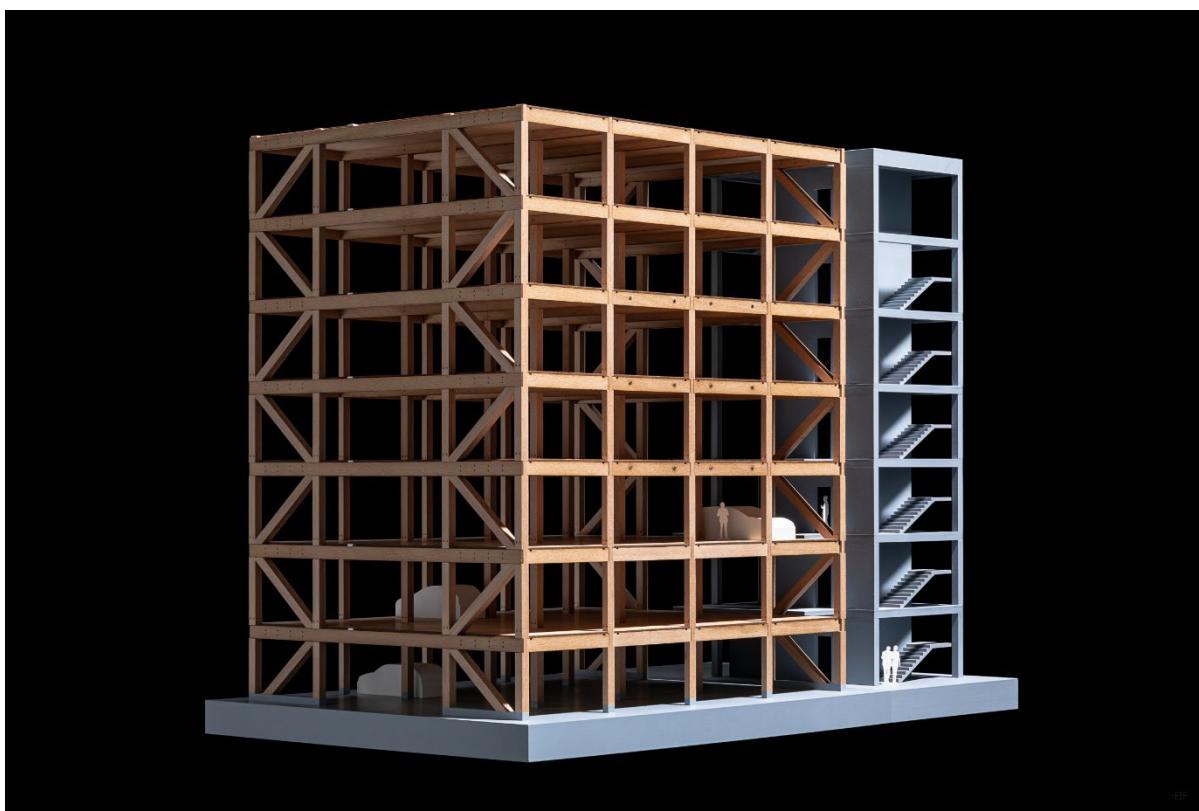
Raumgerüst aus Buchenfurnierschichtholz, t-lab [1]
